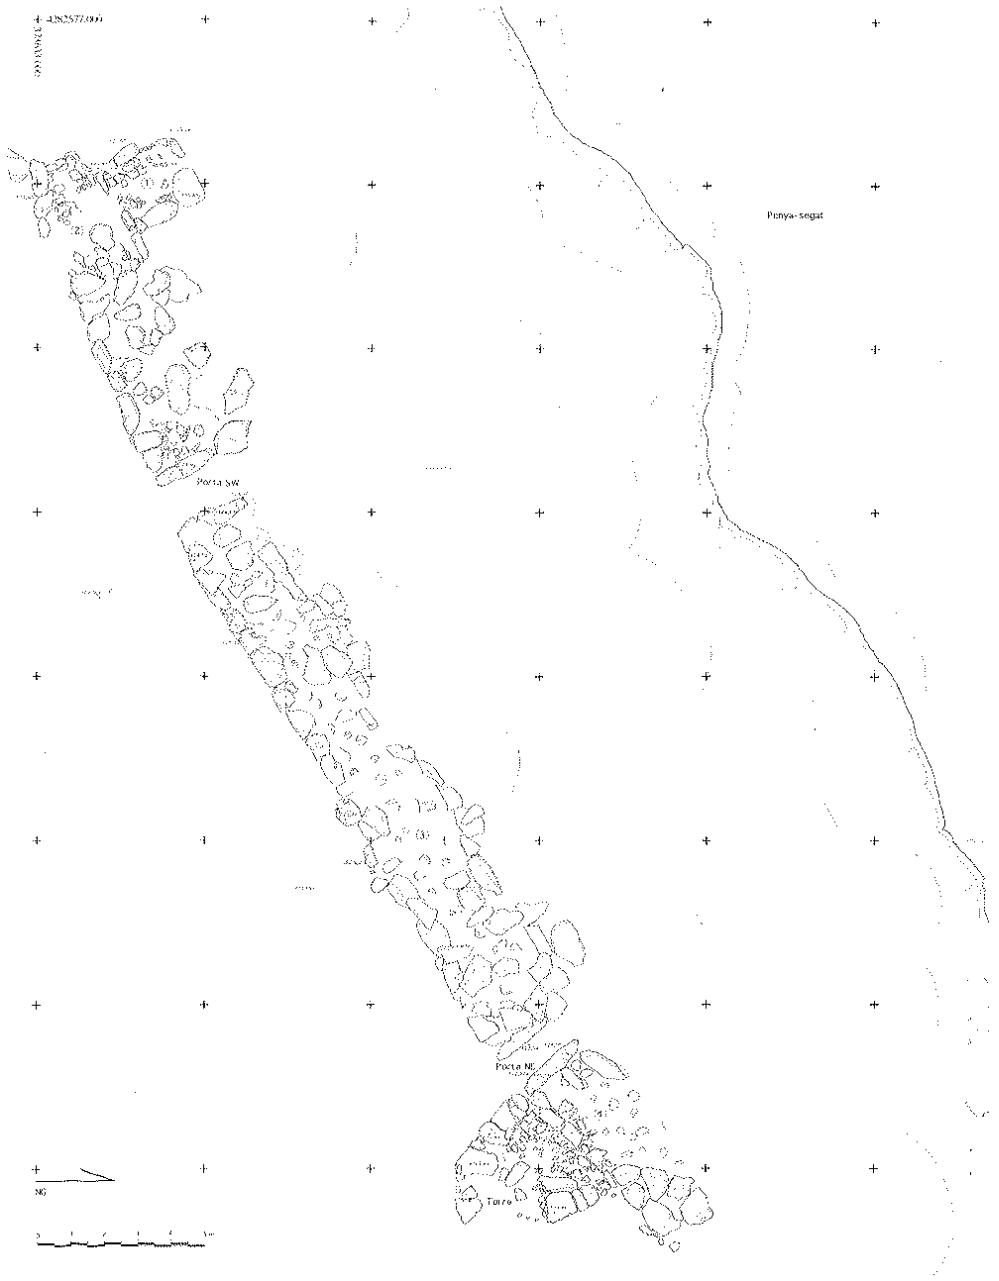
Planta parcial del tram 3 de murada, de la porta NE i de la torre (autors: J. Ramon, M. Colomar i J. M. López)
